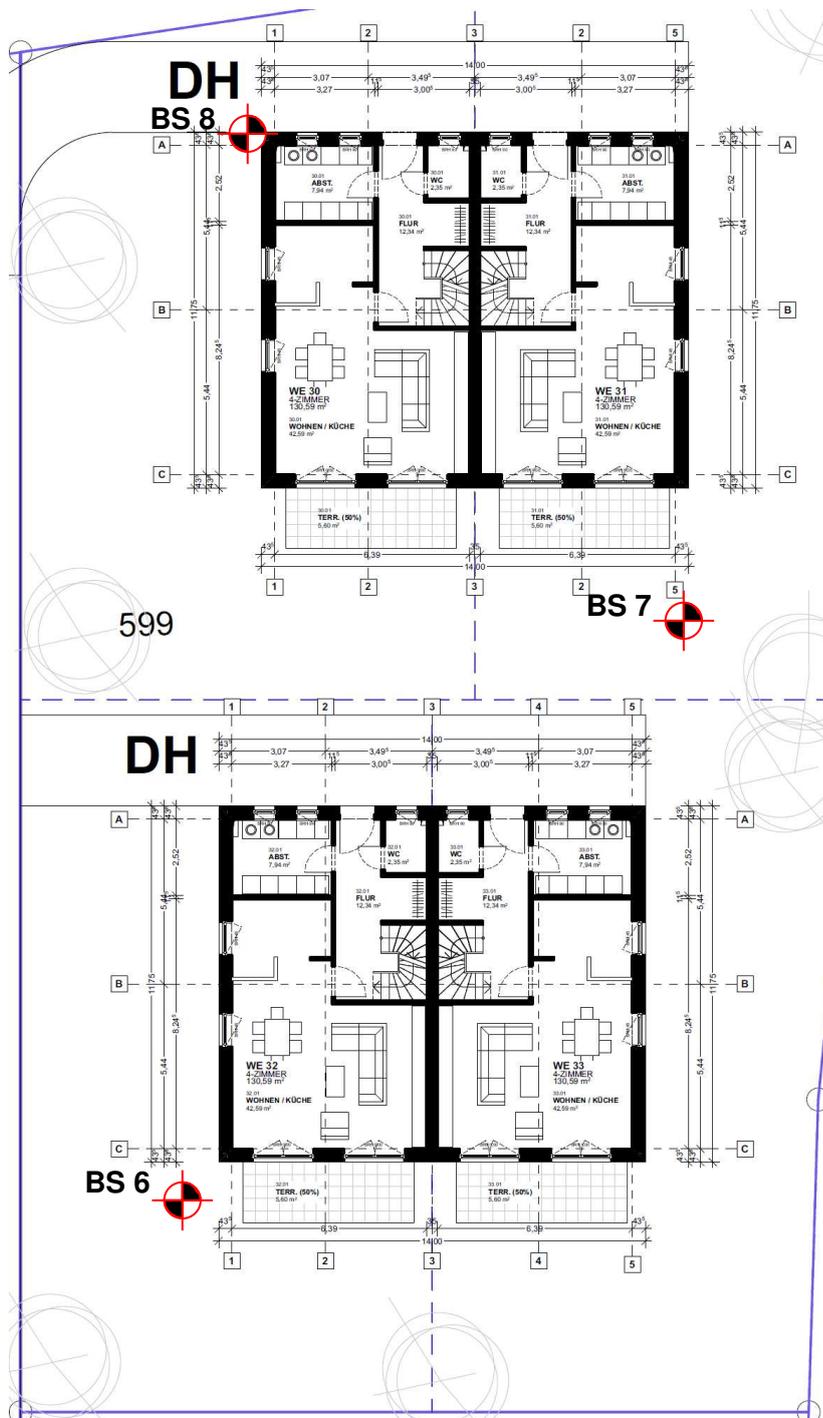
Grundriss Erdgeschoss Doppelhäuser, M 1:250
